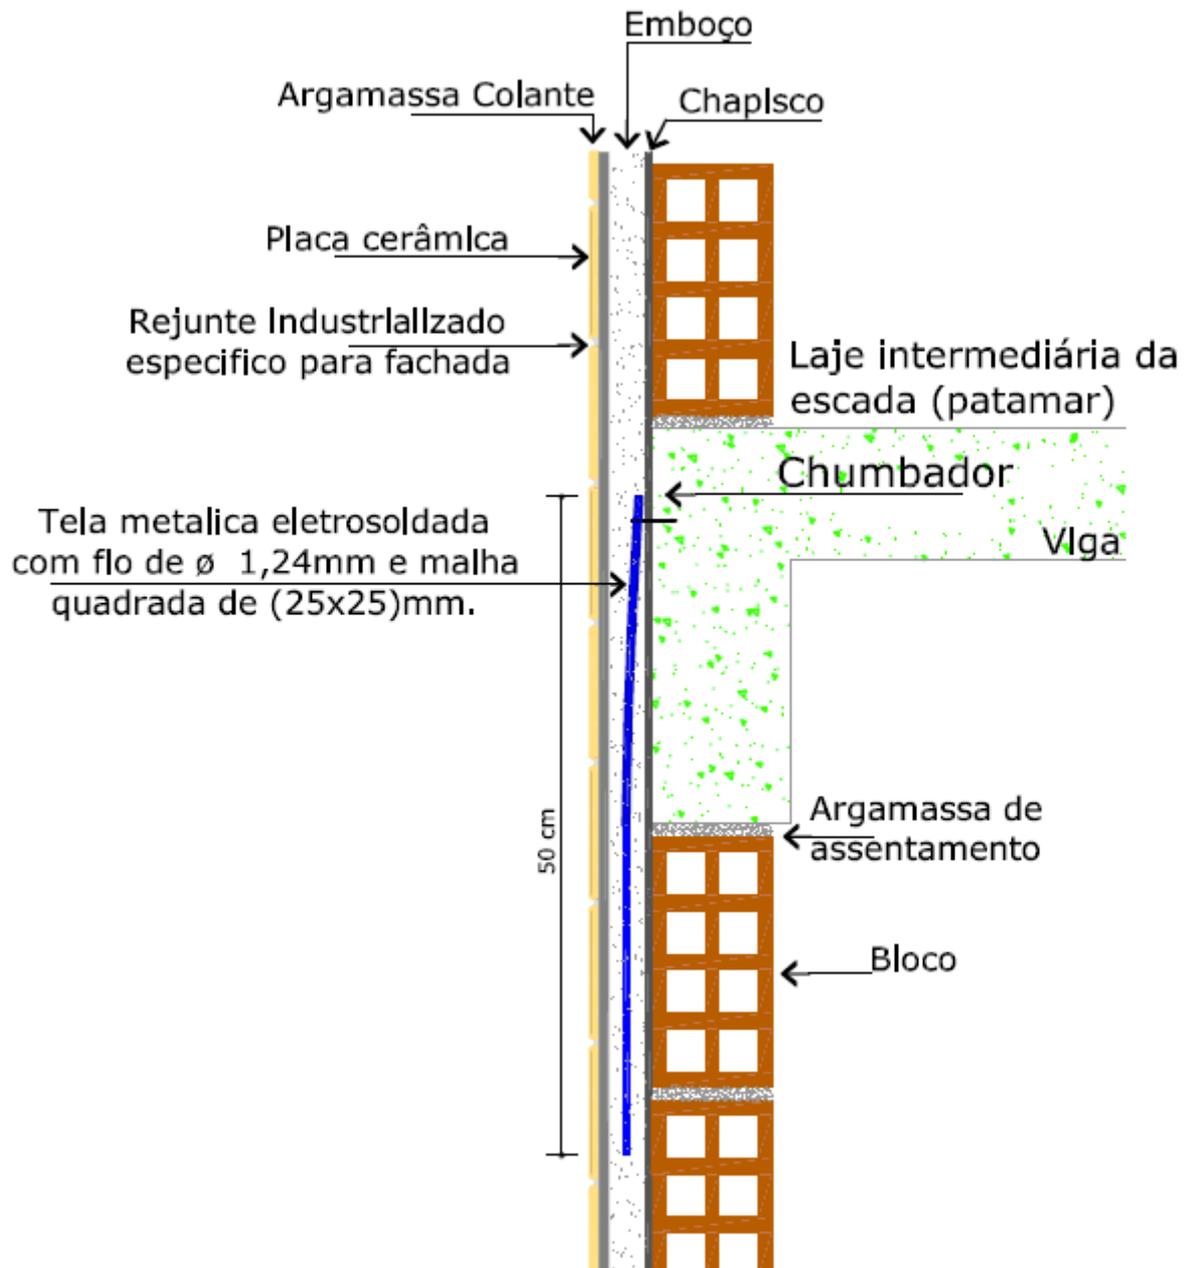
Detalhe da aplicação de reforço com tela soldada em revestimento de argamassa.
